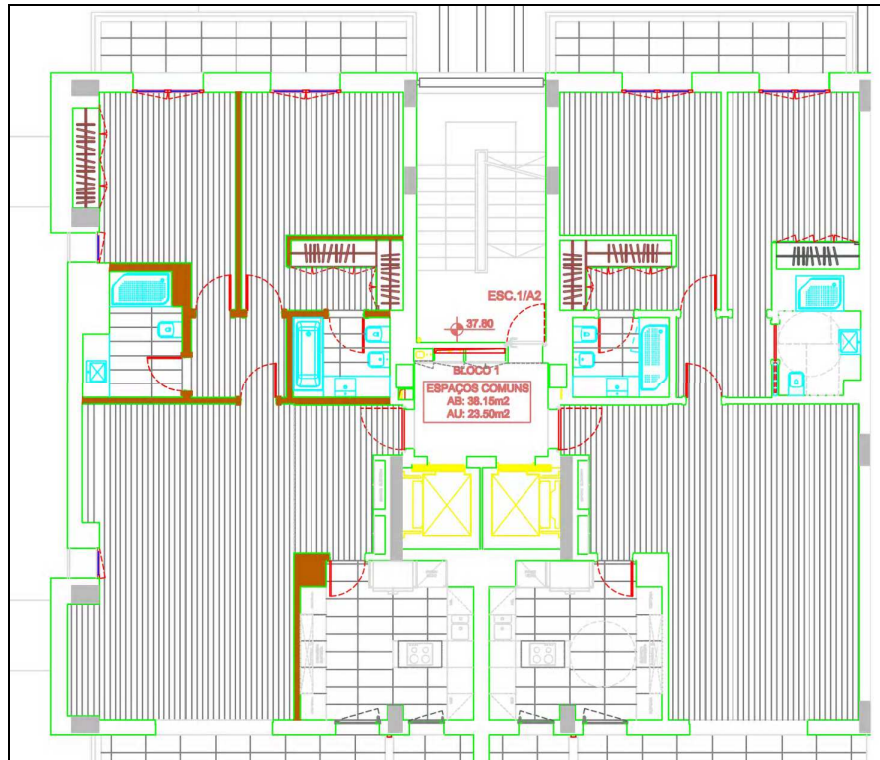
6 - Planta de apartamento T2 (paredes interiores)
